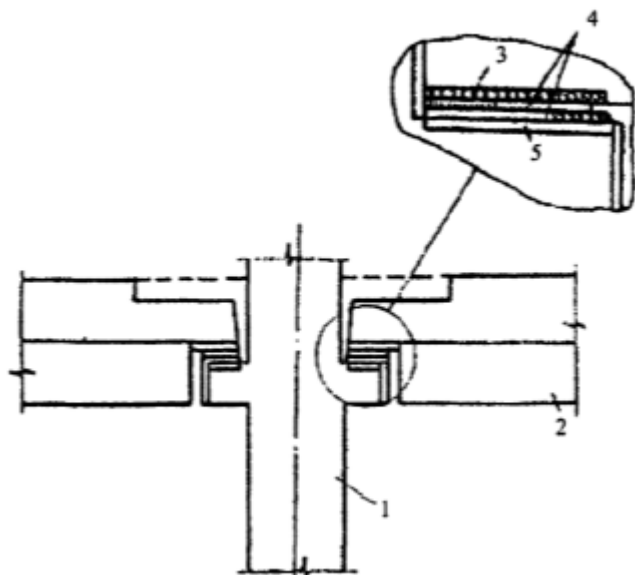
Конструкция узла сопряжения ригелей с колонной
